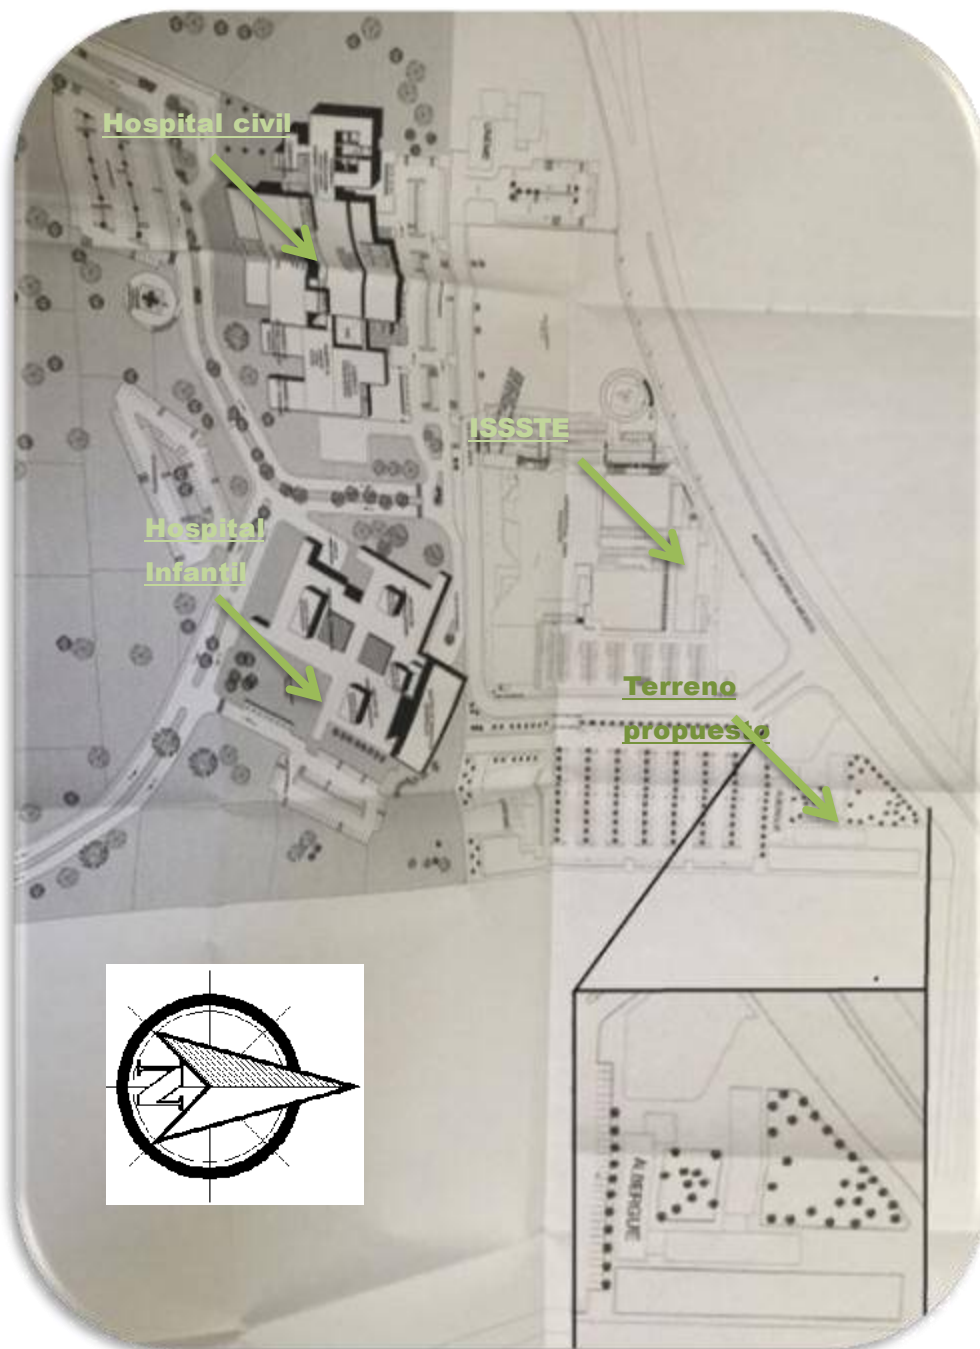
Planta de conjunto de Ciudad Salud. Fuente: Plan Maestro de Ciudad Salud.
